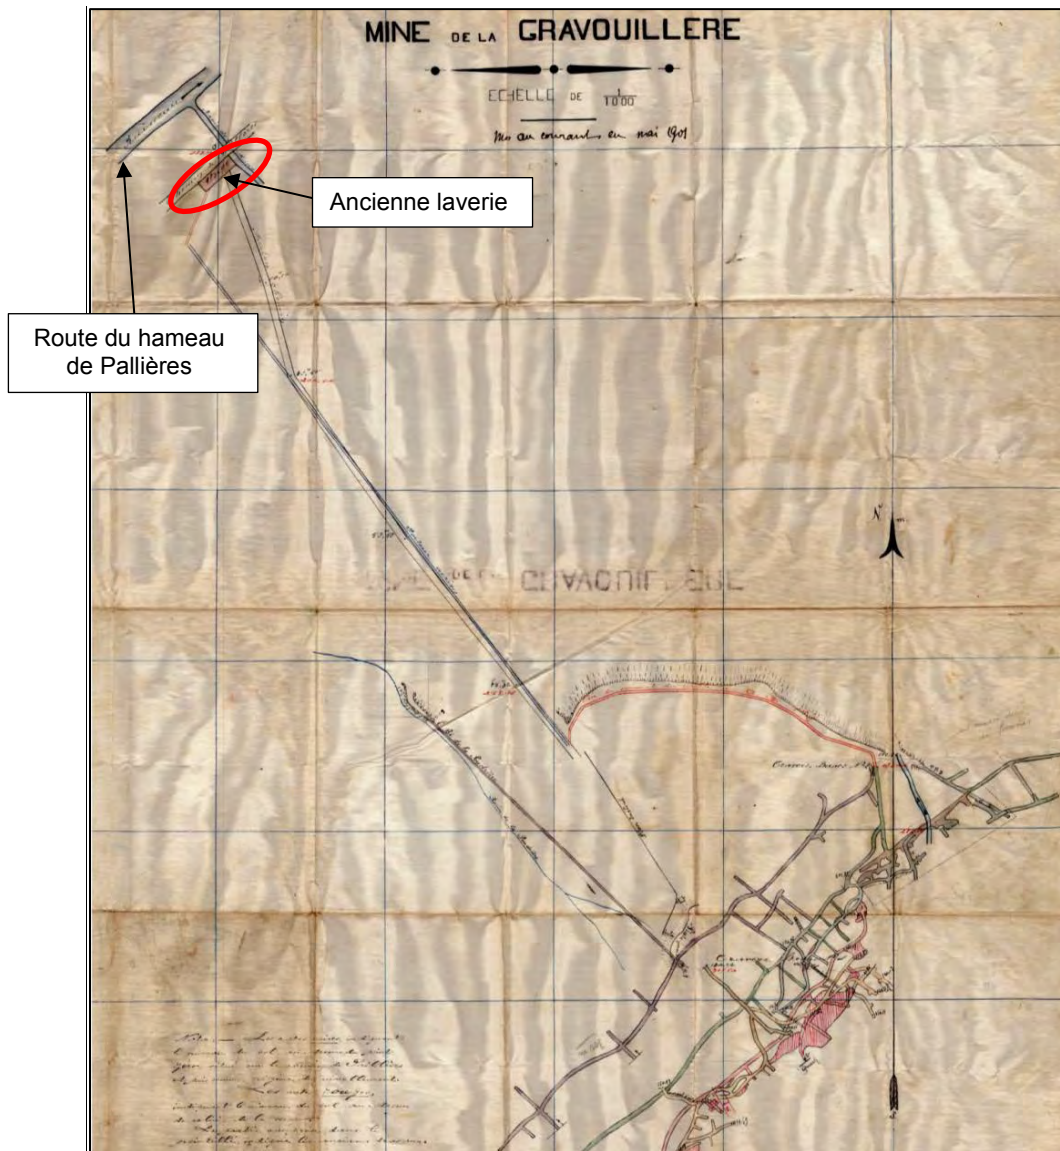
Localisation de l'ancienne laverie à l'aval de la mine de La Gravouillère (source : plan des travaux en 1901, archives DREAL 6.2.10)
